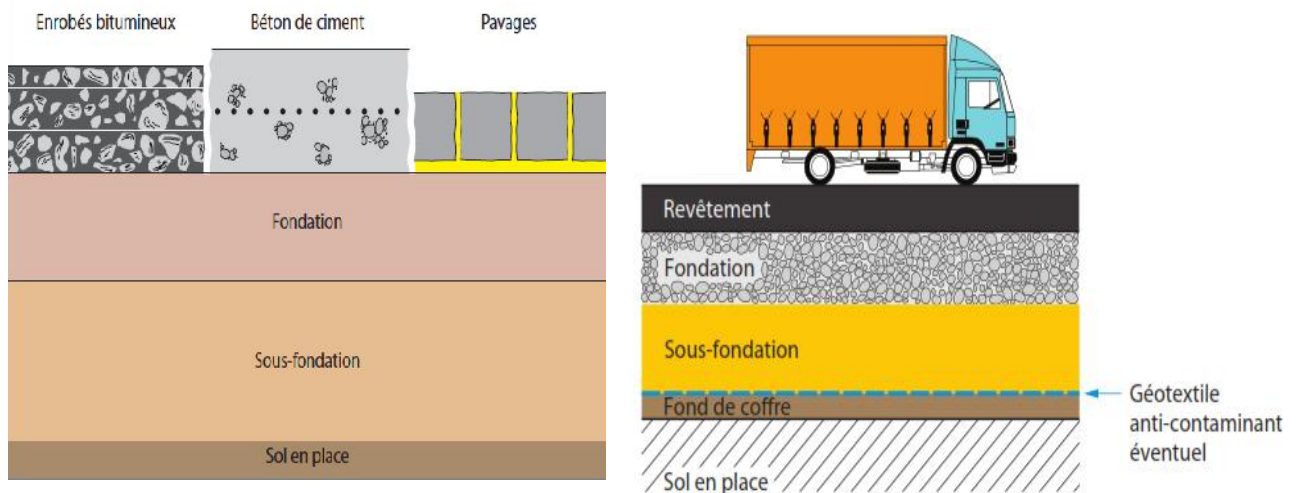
Schéma de principe d'une structure de chaussée à revêtement imperméable (pas l'échelle)
